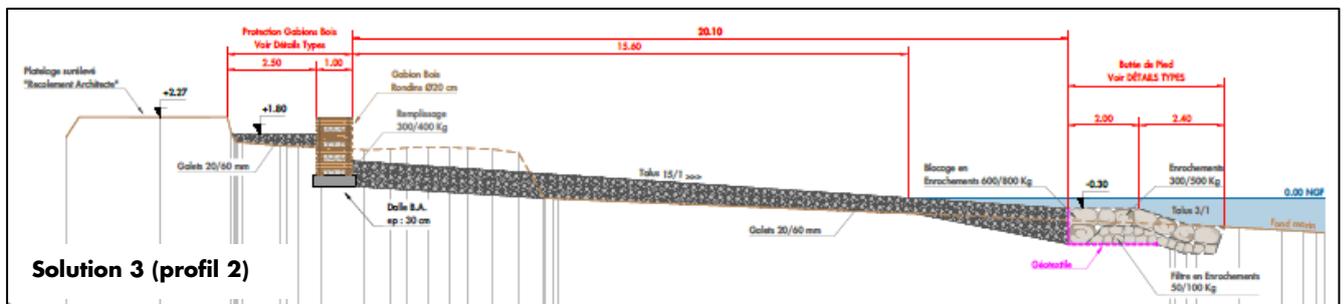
Profil 2 et coupe détaillée de la solution 3 au niveau de la zone de plage étroite (au droit de l'herbier et de la promenade en platelage bois)
